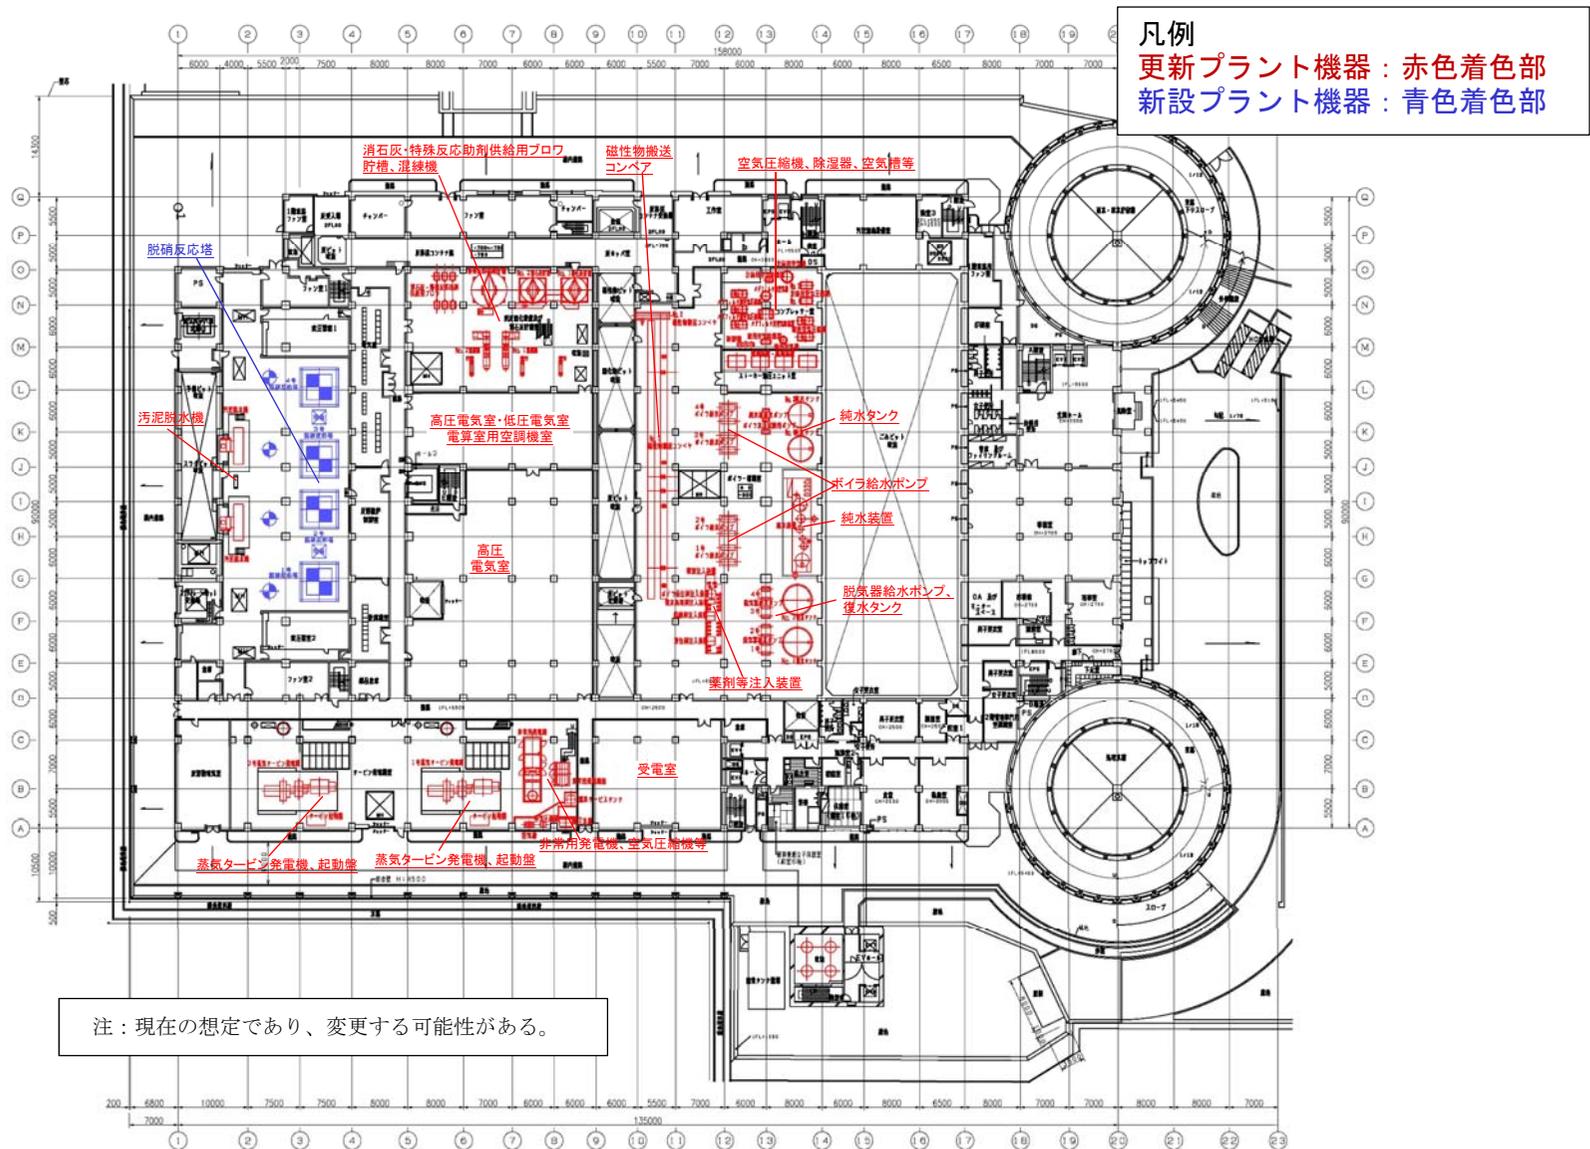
(2) 設備機器の更新箇所 (2階平面図)
